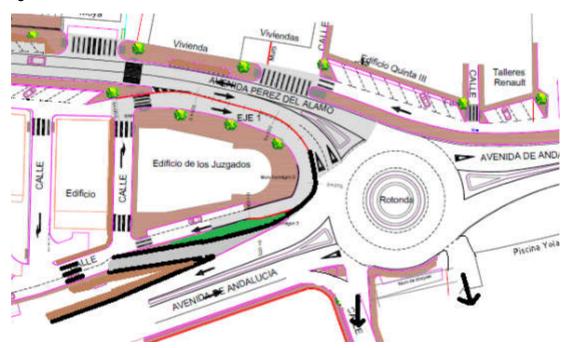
Esquema de la planta del nuevo acceso al barrio de San Miguel desde la avenida de Andalucía. Fuente: Elaboración propia
